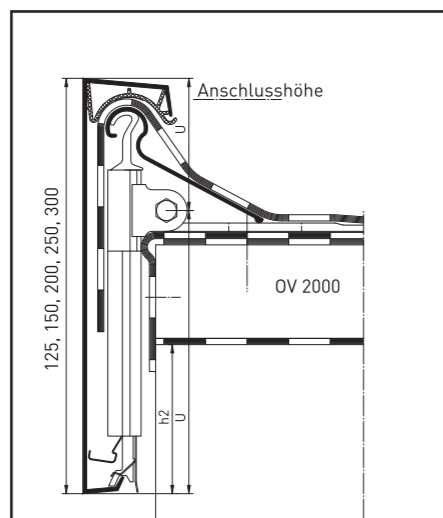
Überstände der Ortgangverkleidungen, sowohl nach oben als auch nach unten über die Fassaden, müssen nach den jeweiligen Bauhöhen und Dachneigungsgruppen gewählt werden (siehe Flachdachrichtlinien). Ab einem Überstand U = 180 mm ist je nach statischer Anforderung eine oder mehrere stirnseitige Befestigungen erforderlich.
